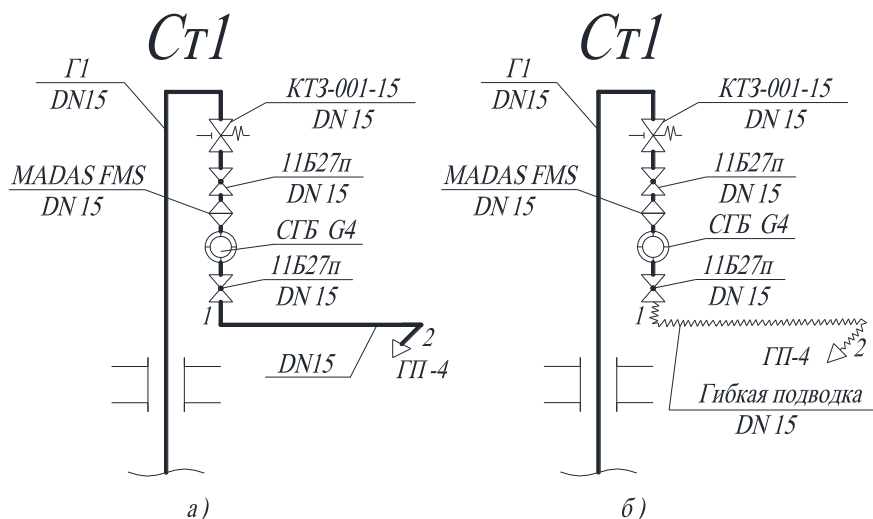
Пример монтажа газопроводов из гофрированных труб при реконструкции газовых сетей жилого дома
